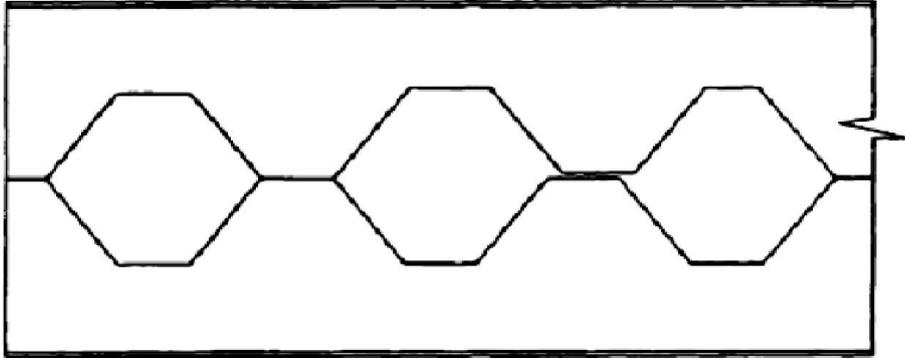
Ruine par écoulement du joint de soudure [13].
